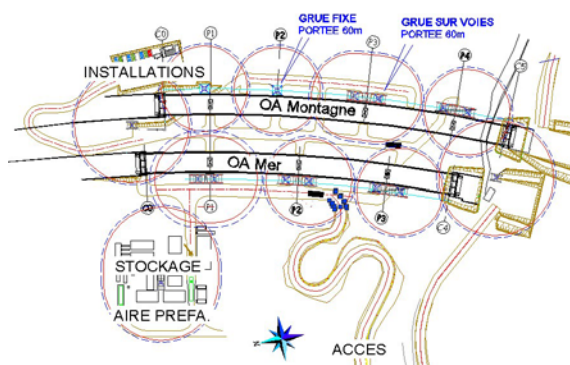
Vue en plan des installations de chantier des viaducs de Fleurimont. / Bird's eye view of the worksite facilities of the Fleurimont Viaducts
